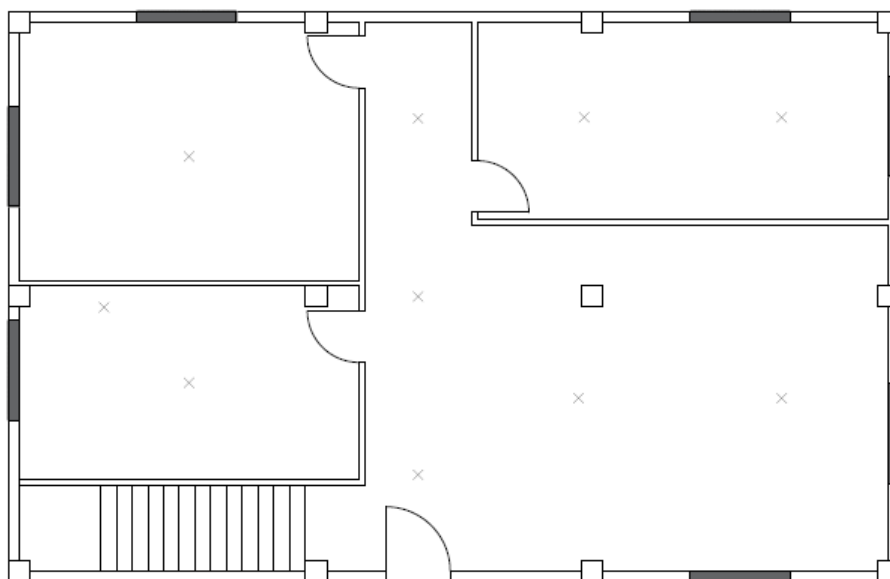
Plano Iluminación de la Vivienda Básica planta baja.
